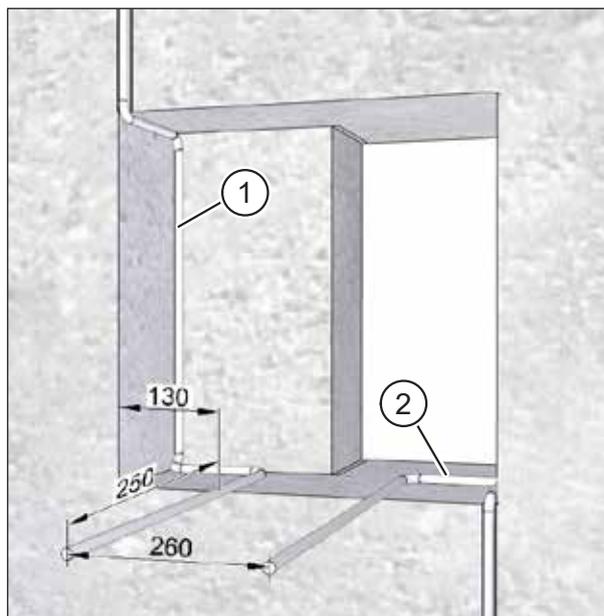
Poser les câbles de raccordement, dimensions en millimètres
